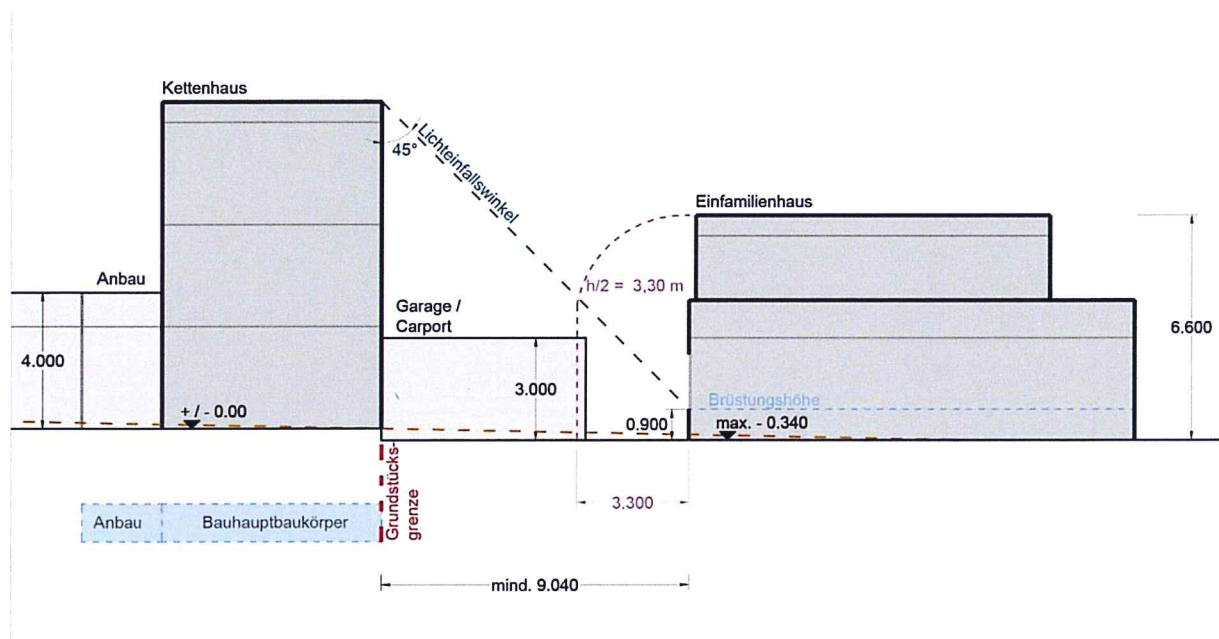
Schnittansicht Kettenhaus/ Einfamilienhaus – Garage/ Carport mit Grenzanbau zum Kettenhaus, o. M.
